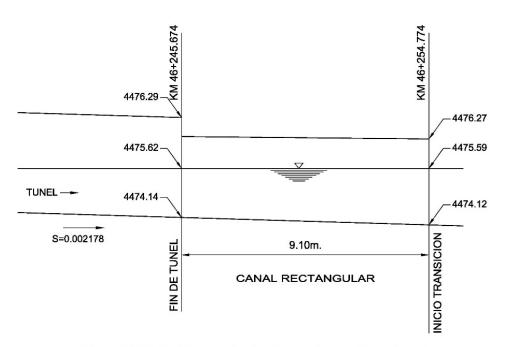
Perfil longitudinal del tramo de sección rectangular
